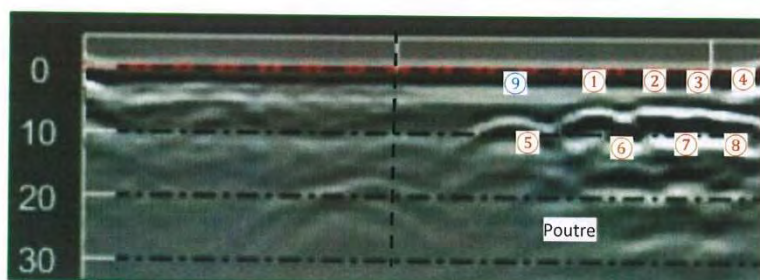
Radargramme du profil vertical sur poutre de rive aval P6 et about du tablier
